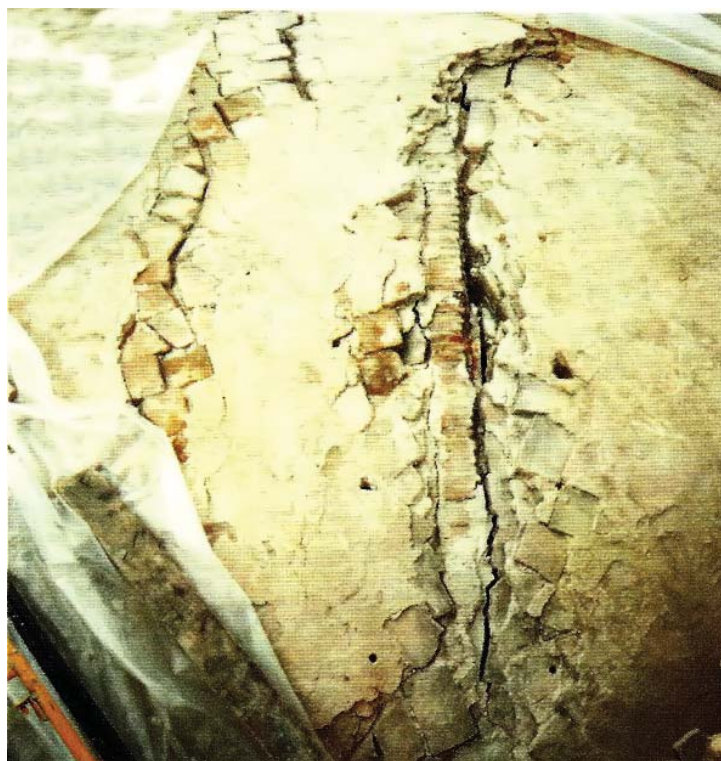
Extradós de las bóvedas donde podemos apreciar la plementería de ladrillo
